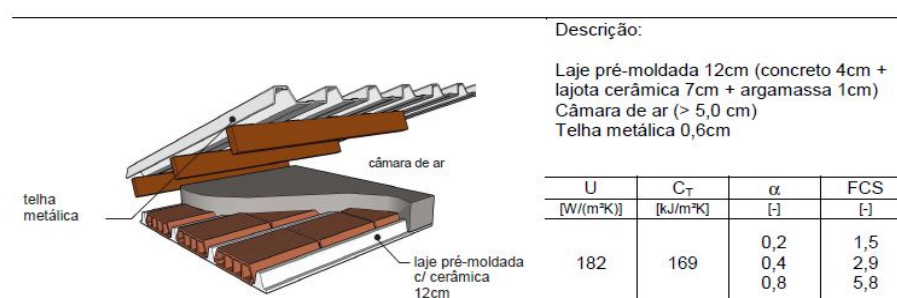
Telha metálica com laje pré-moldada 12,0cm feito de concreto, lajota e argamassa (LabEEE 2010)
